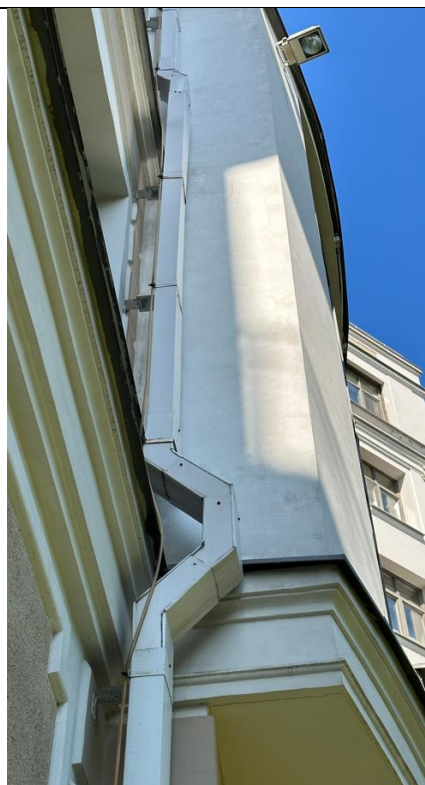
Общий вид условной части №5 восточной стороны фасада здания и дефекты в виде растрескивания штукатурки и окраски на фасаде, откосах и балконах
